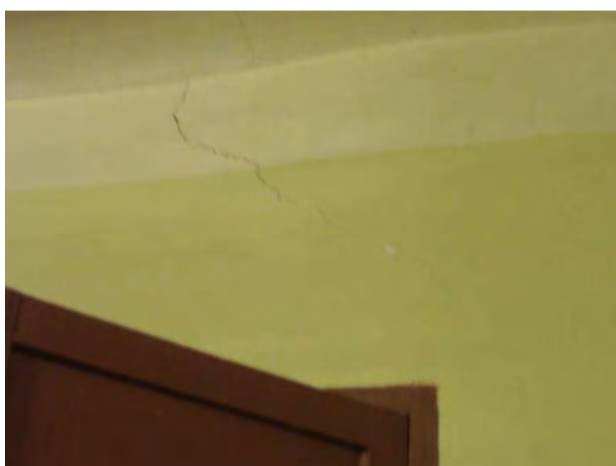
Cap. 6: Grieta por encima de la puerta
